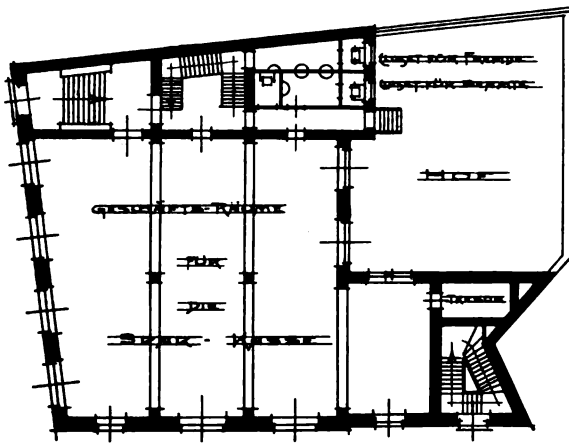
Erdgeschoss der Sparkasse an der Ehrenstrasse.
